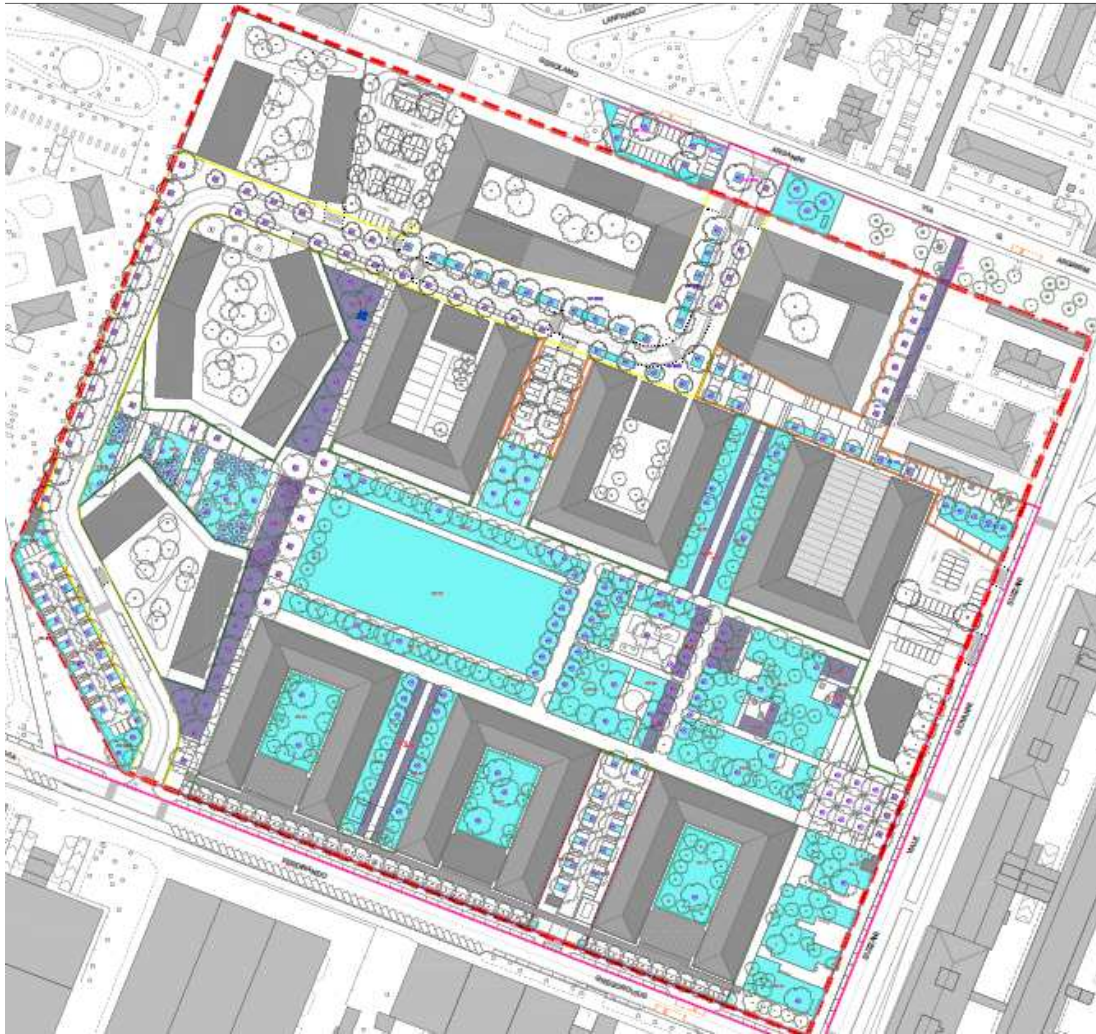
Stralcio del progetto dell'irrigazione (Tavola P23f)
